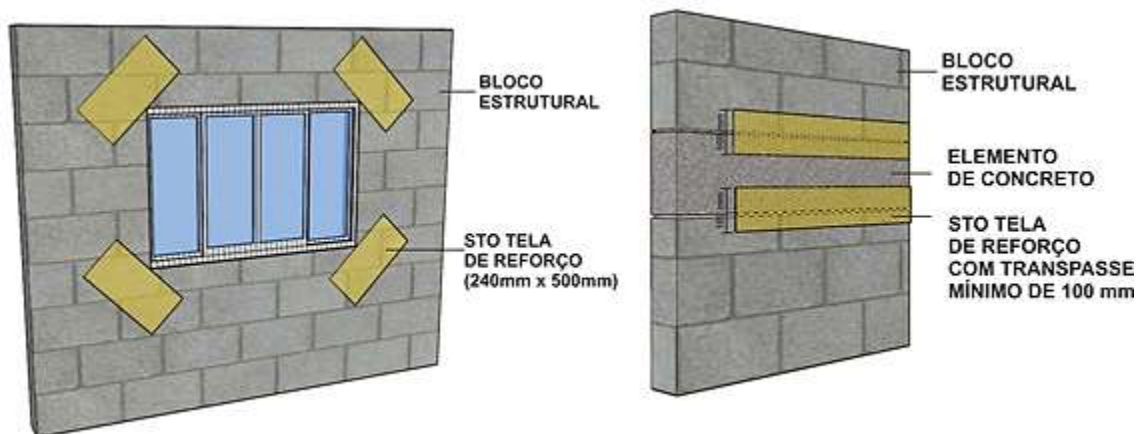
Ilustração da aplicação da tela de fibra de vidro nas interfaces com elemento de concreto (laje) e nos vértices das aberturas.
